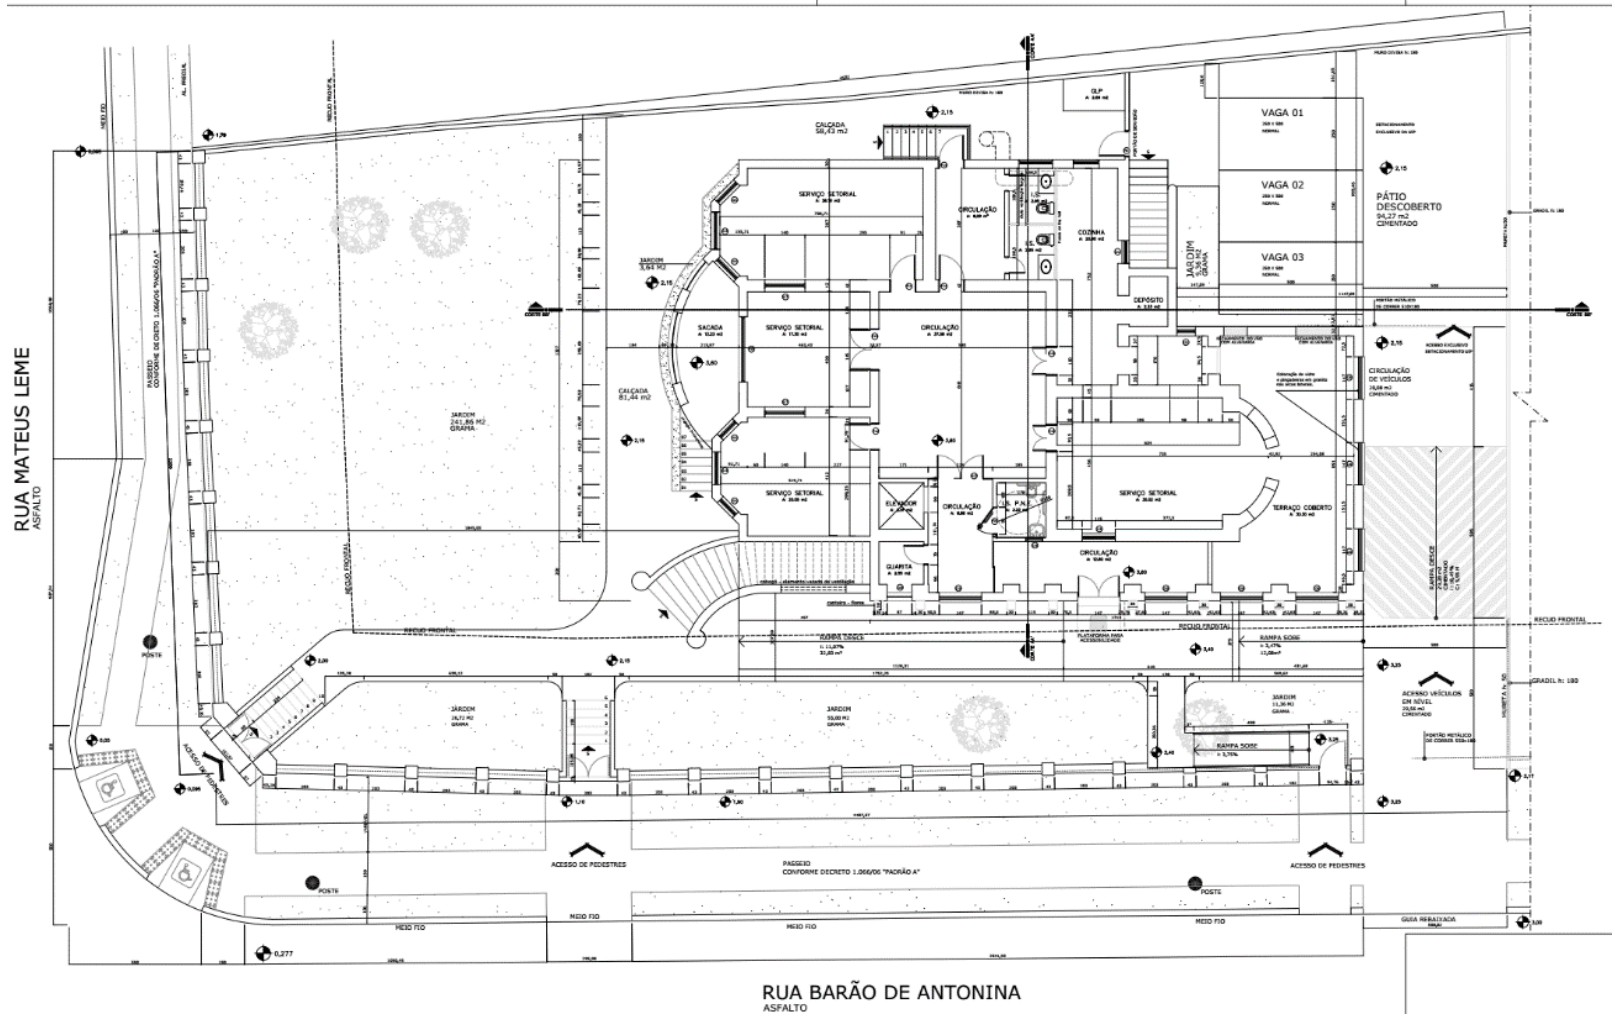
Projeto de restauro planta Térreo - Residência Vila Sophia
